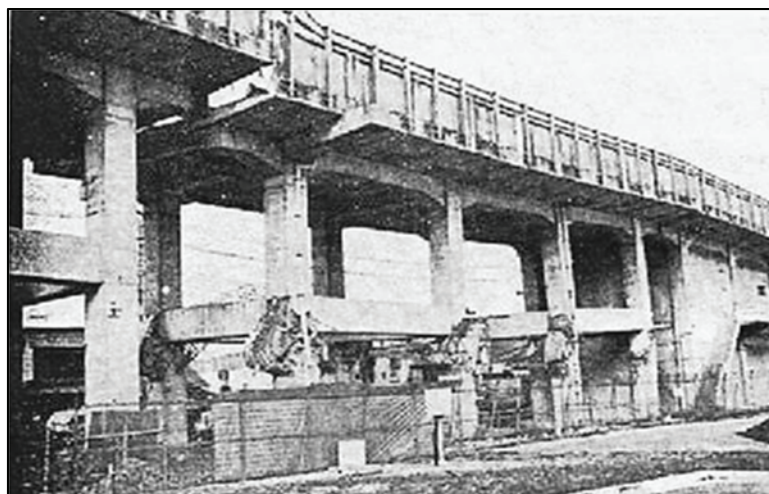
Daños en la estructura de concreto armado del tren bala. (Fuente: Park et al., 1995, p. 62)
